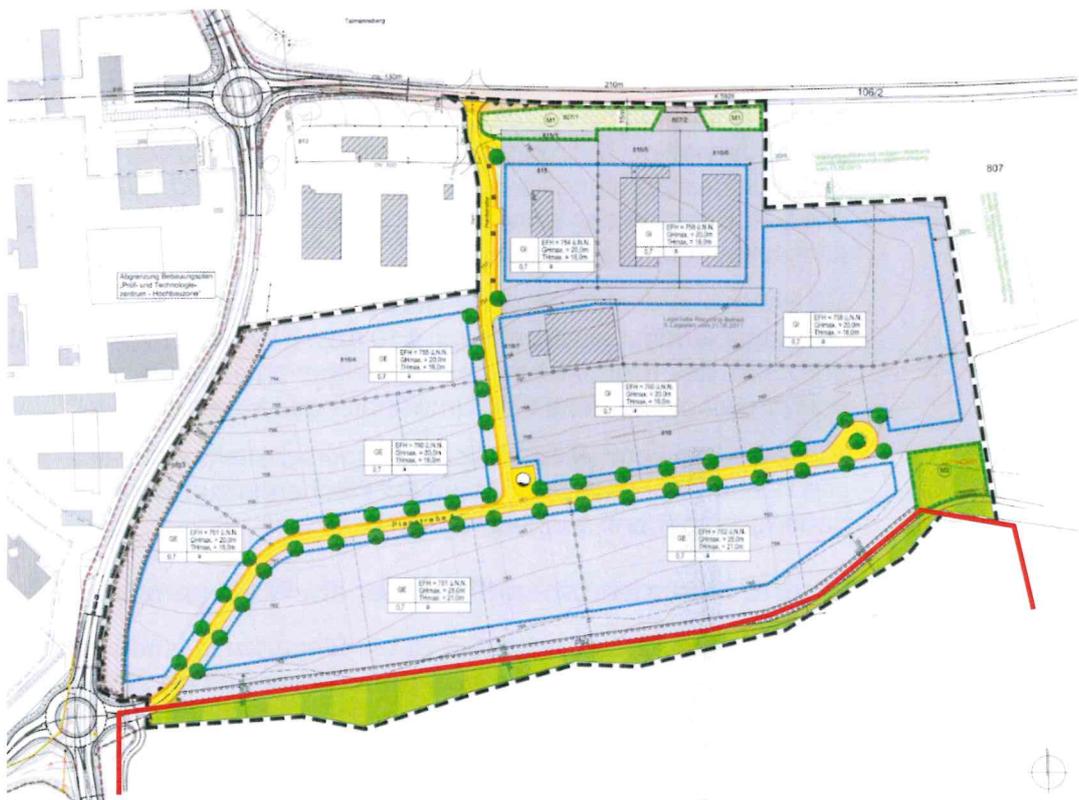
Bauungsplan „Donau-Hegau I“ mit Änderungsbereich in Rot.
